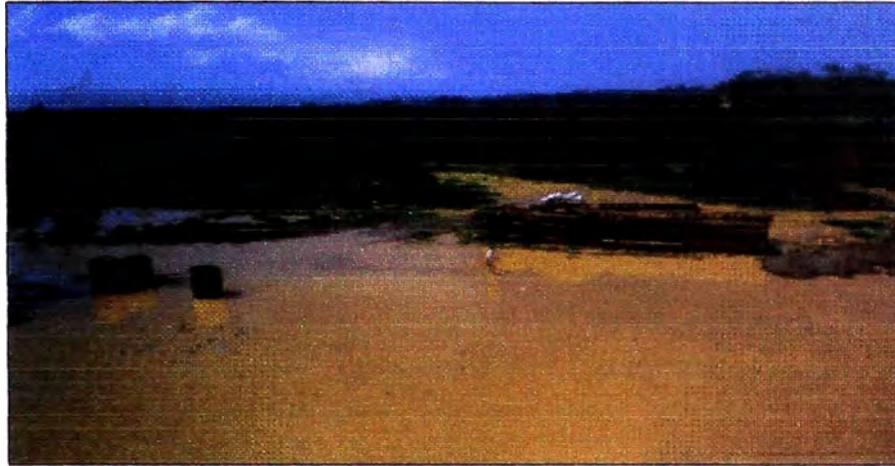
Encofrado de Losa del Tablero del Pte Franco.
